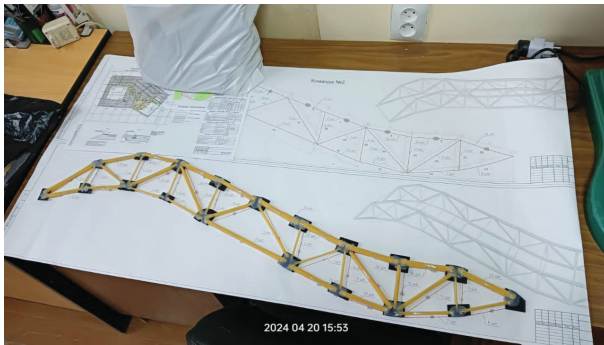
Схема для сборки макета и изготовленная ферма из макарон
